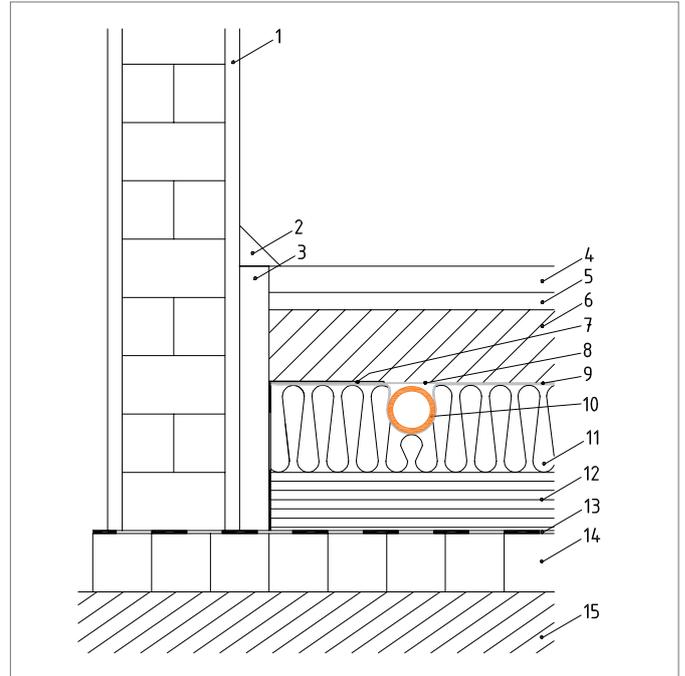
Exemple de construction d'un système chauffage / refroidissement par le sol en construction sèche
